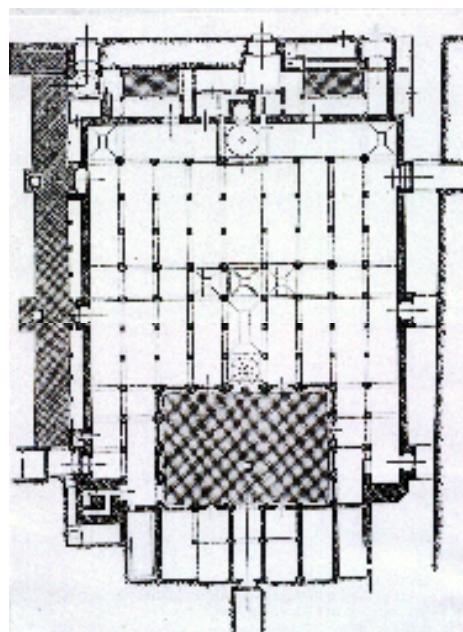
مسقّط أفقى لجامع ابن صالح بمراكش.
